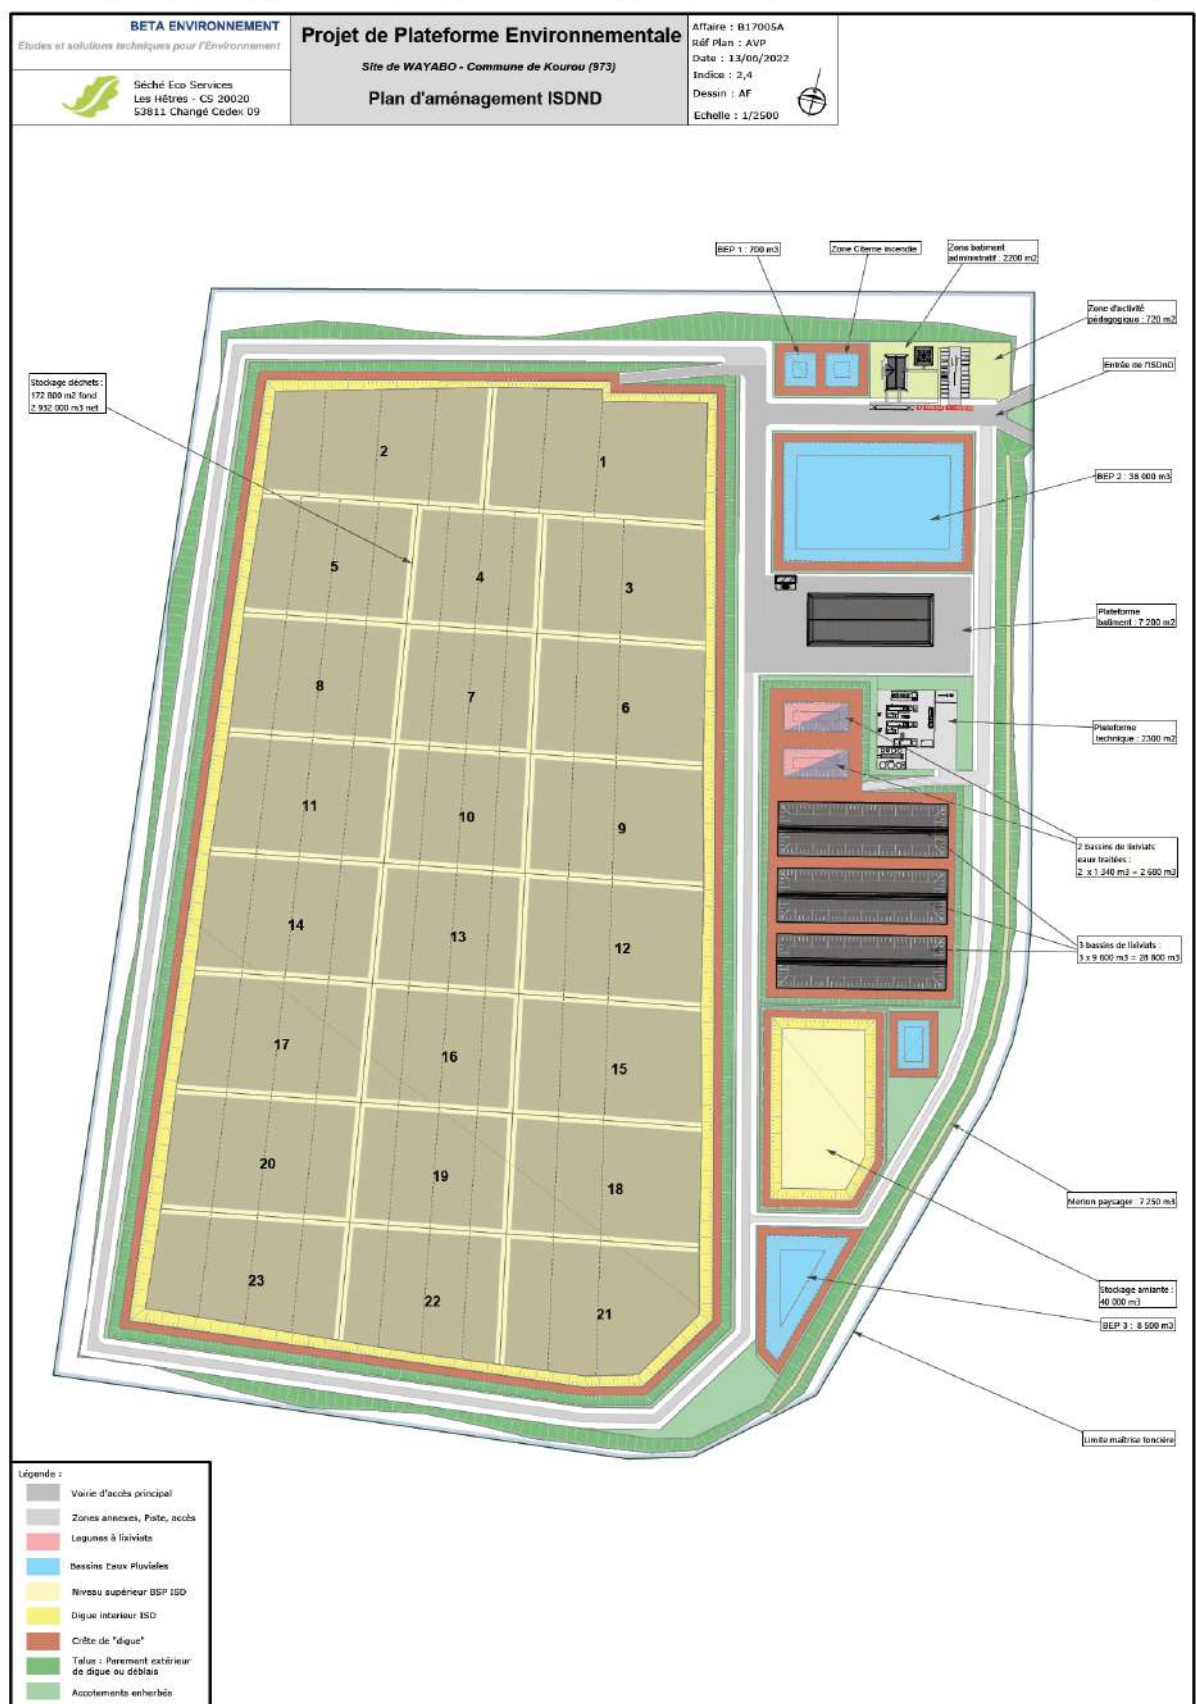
Plan de l'installation (Source : BETA Environnement)
